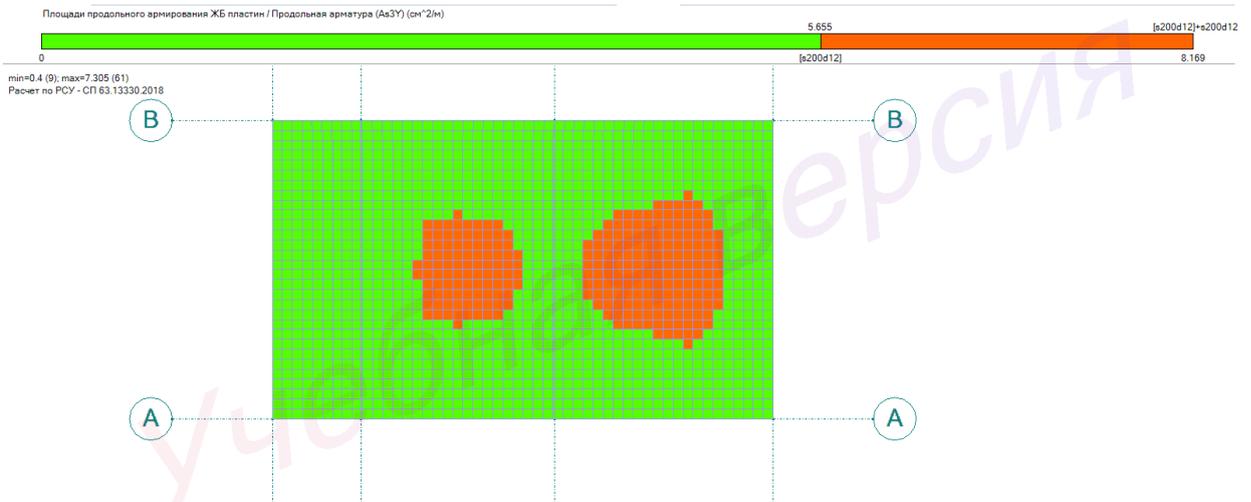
«Продольное армирование нижней зоны по оси X» [11]
